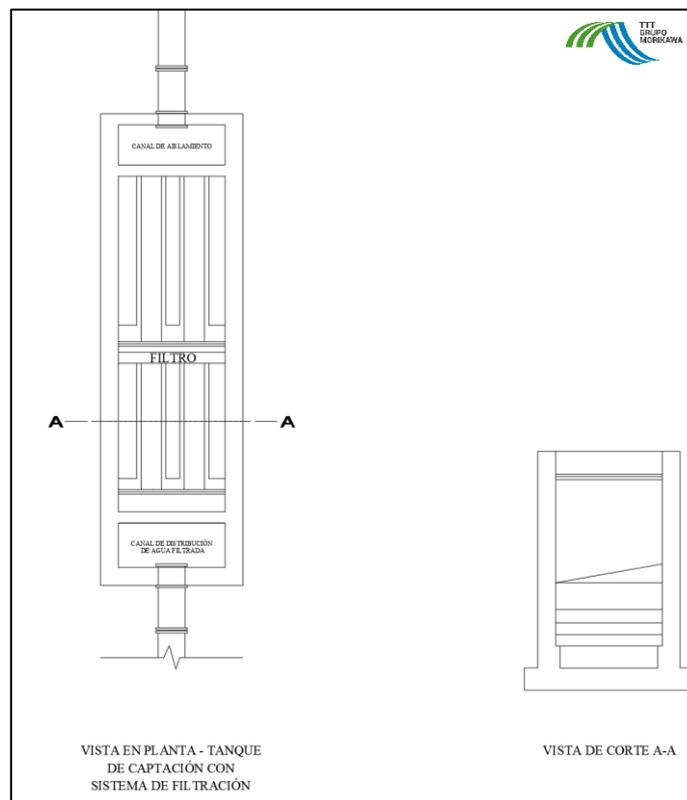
VISTA EN PLANTA Y CORTE DE TANQUE DE CAPTACIÓN CON SISTEMA DE FILTRACIÓN / FUENTE: PROPIA
